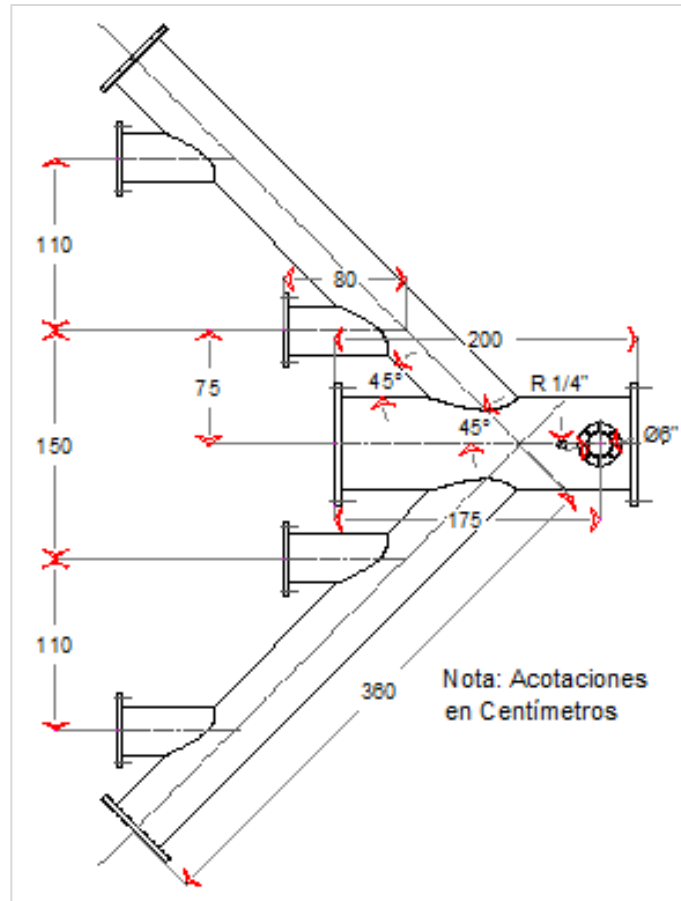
Detalle en planta de “manifold” de acero del tren de descarga.
